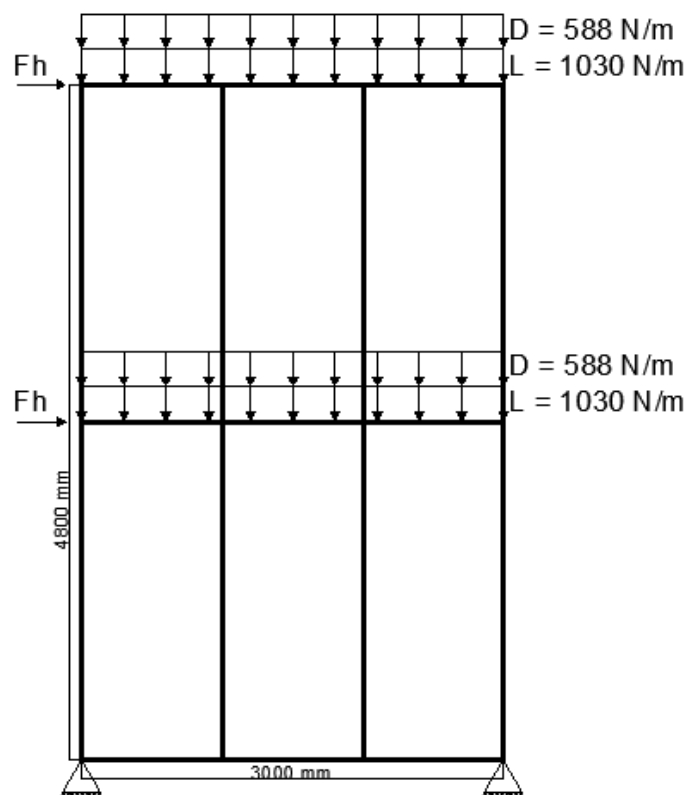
Distribución de cargas y apoyo para las condiciones A y B.
